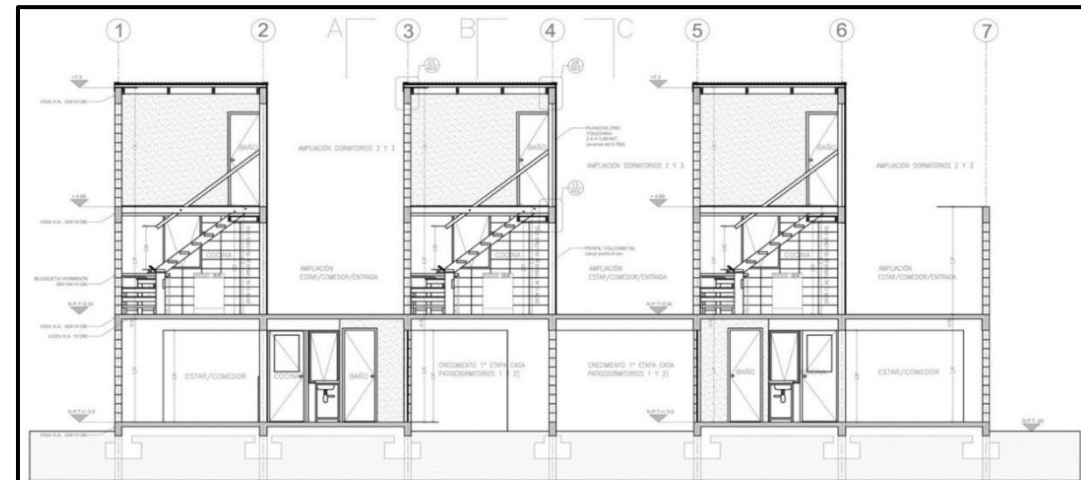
Sección Longitudinal de Propuestas de viviendas progresiva en Chile.
